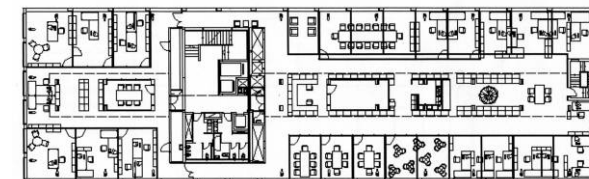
Regelgeschoss - Grundriss 1.0G
